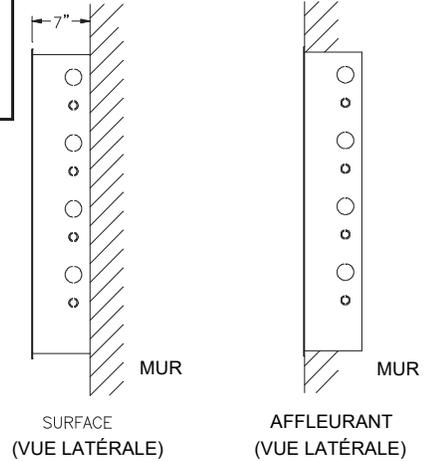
Instructions d'installation et dimensions du boîtier BB-5008
